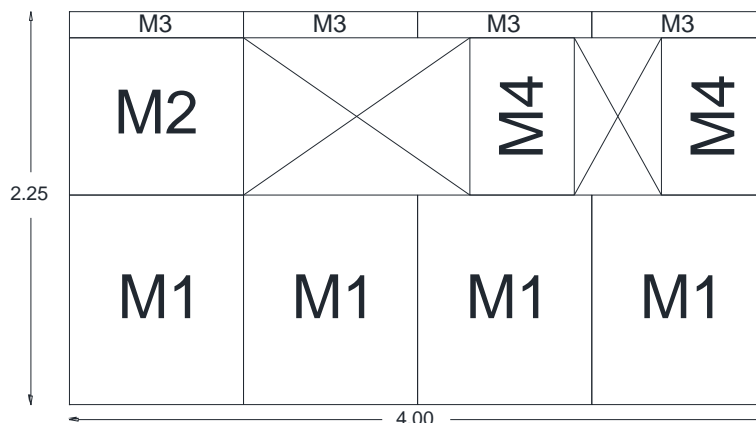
Armado de módulos para el muro 1 de la vivienda tipo social.
